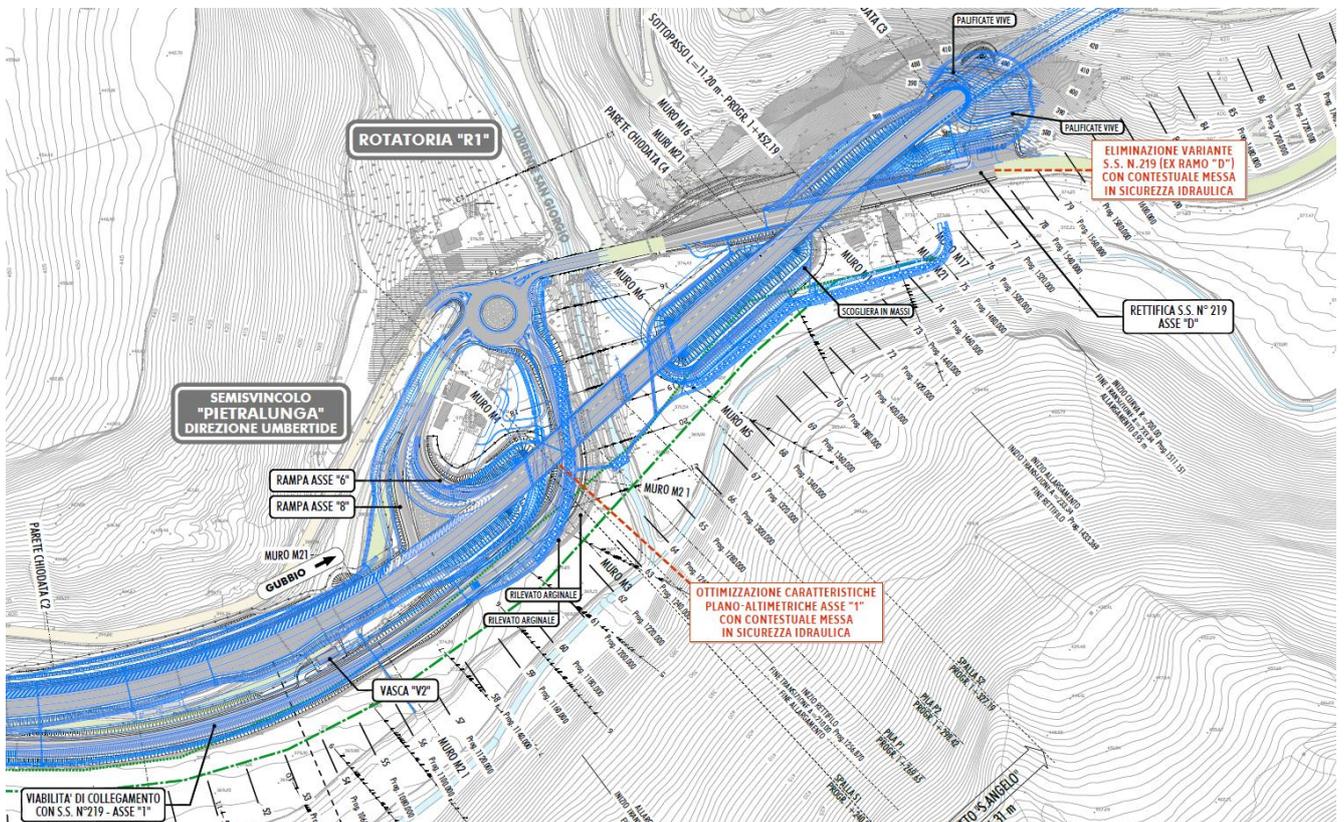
PLANIMETRIA DI RAFFRONTO CON IL TRACCIATO DEL PROGETTO DEFINITIVO IN CORRISPONDENZA DEL SEMISVINCOLO “PIETRALUNGA” DIREZIONE UMBERTIDE
